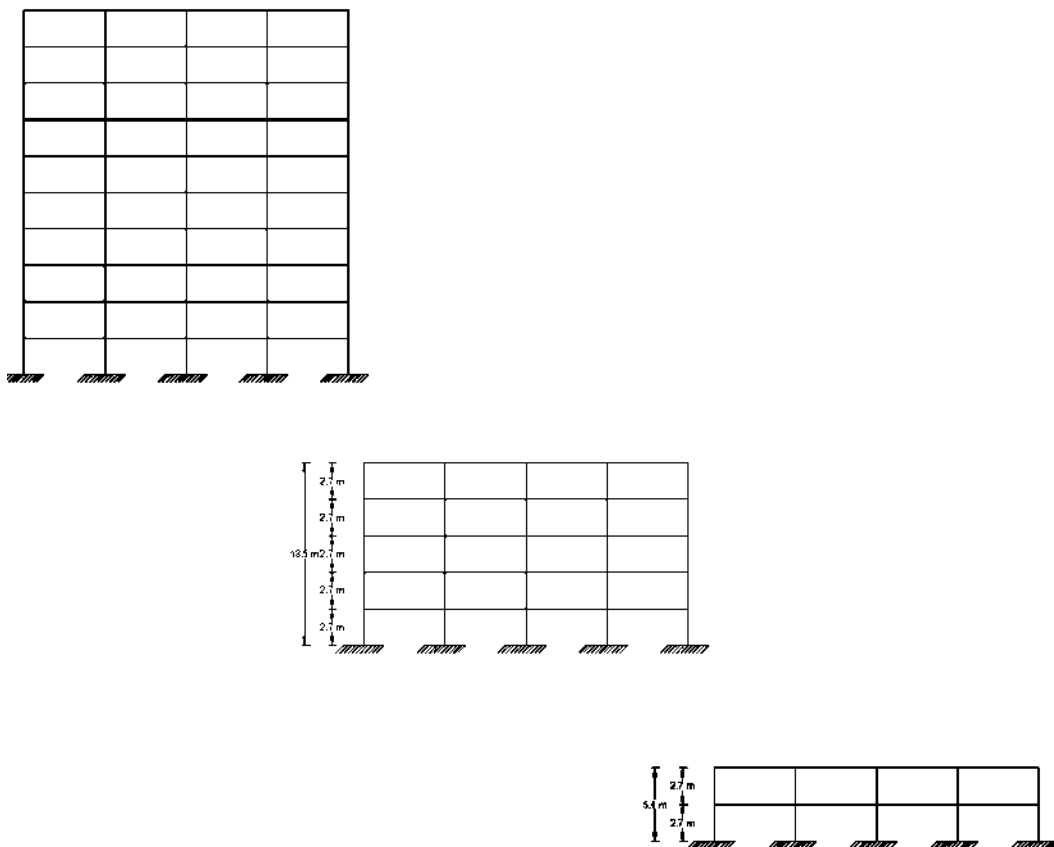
Vista en elevación de modelos estructurales; 10, 5 y 2 niveles.
